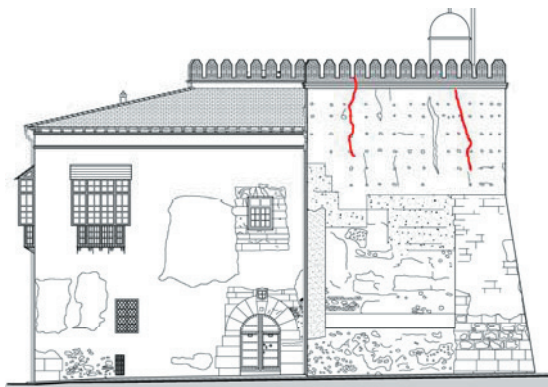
Alzado Norte, fisuras en la fábrica de tapial.
